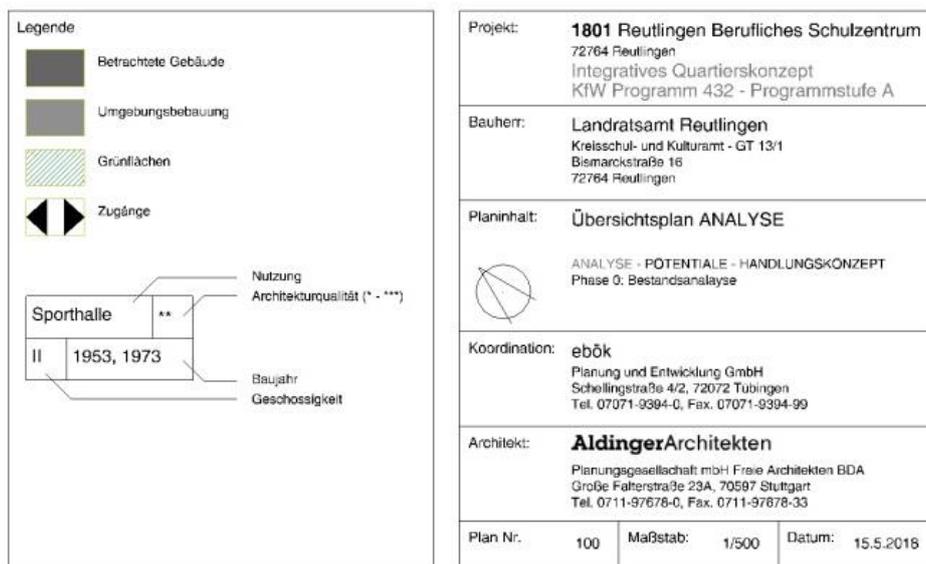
Plankopf Übersichtsplan Analyse. Der Plan befindet sich im Anhang zum Bericht.
